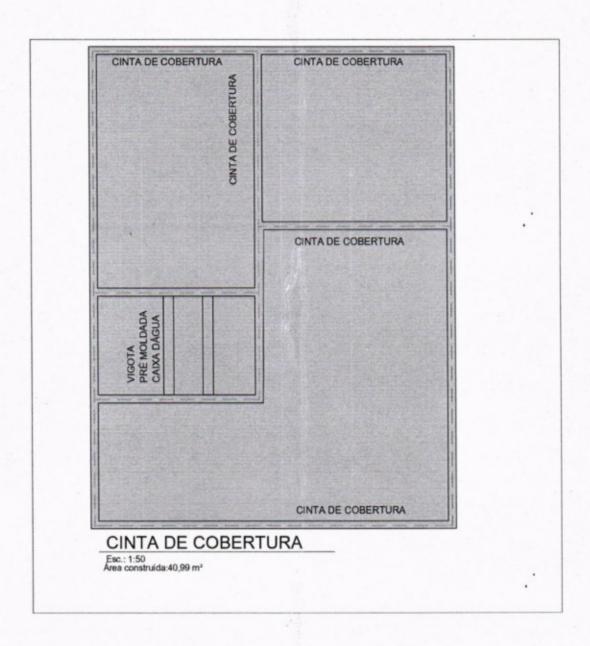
Planta baixa – Cinta de cobertura Fonte: o próprio autor
